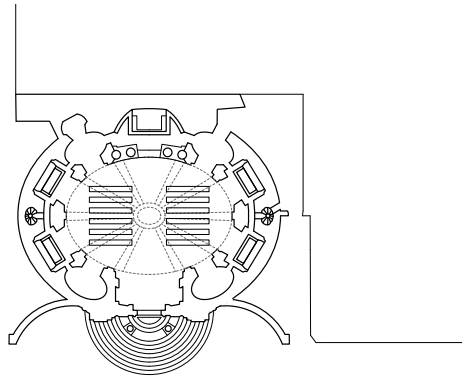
Planta Sant'Andrea Al Quirinale, Bernini. Roma, 1670
